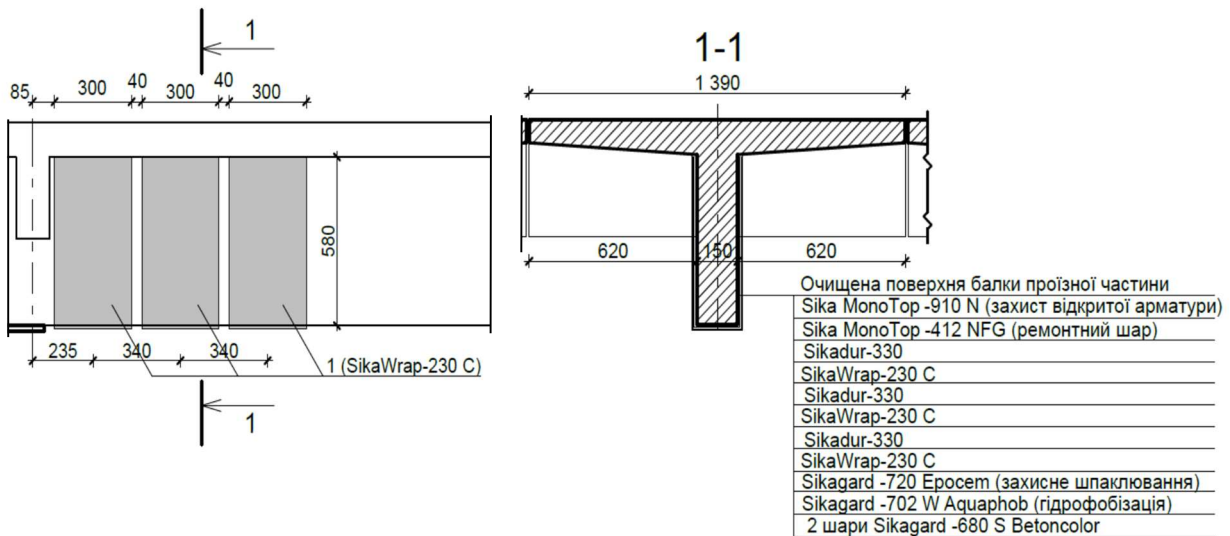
Проектне рішення з підсилення балок композитним вуглепластиковим матеріалом Sika Wrap
